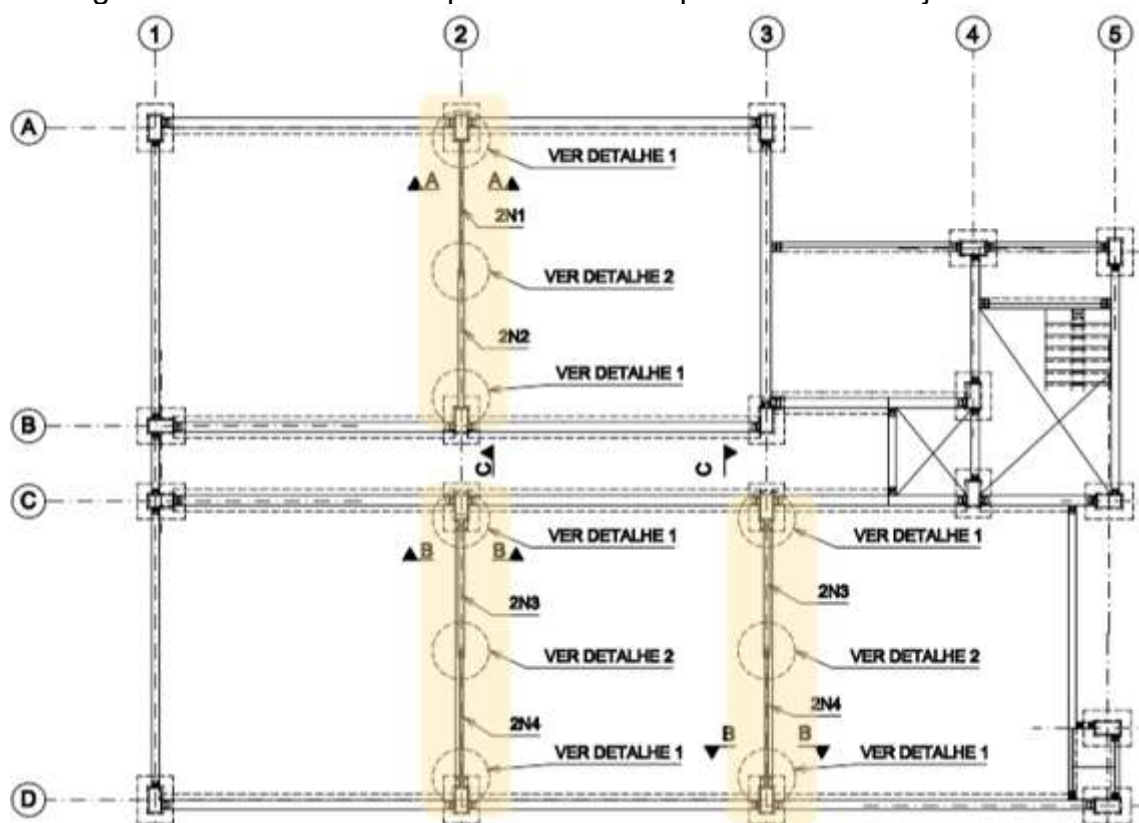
Armadura complementar soldada entre pilares, sobre a laje
